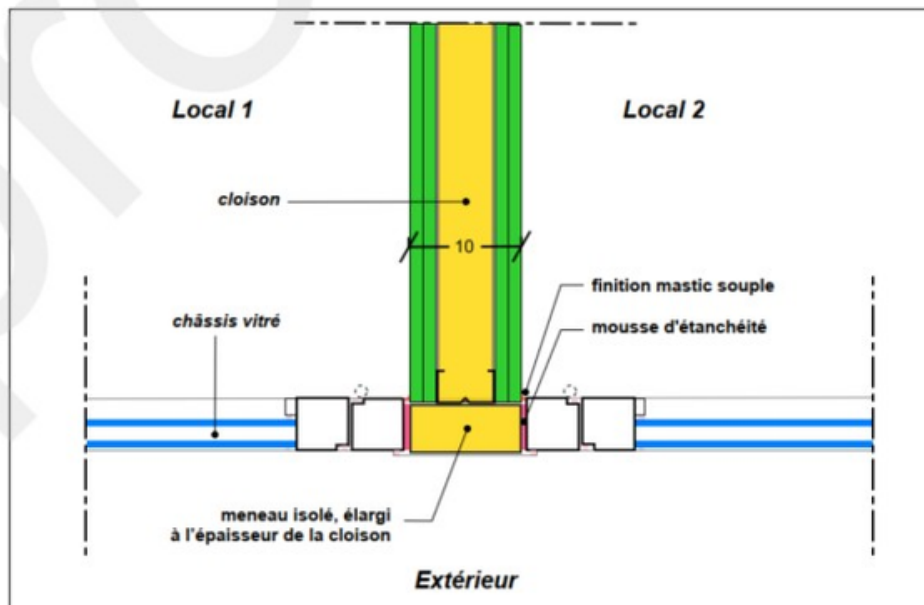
Principe de jonction cloison - façade avec meneau élargi
